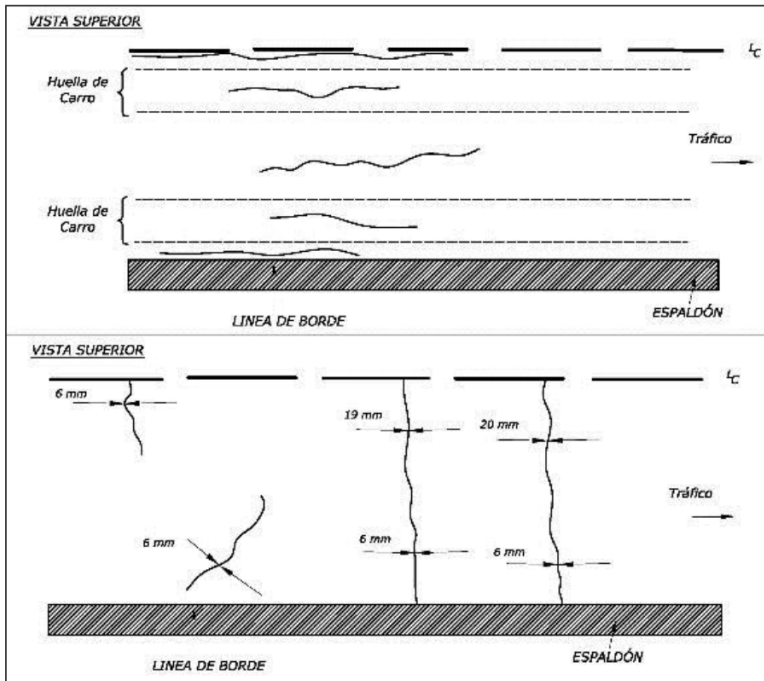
Esquema Grieta Longitudinal y Transversal – Pavimento Flexible
